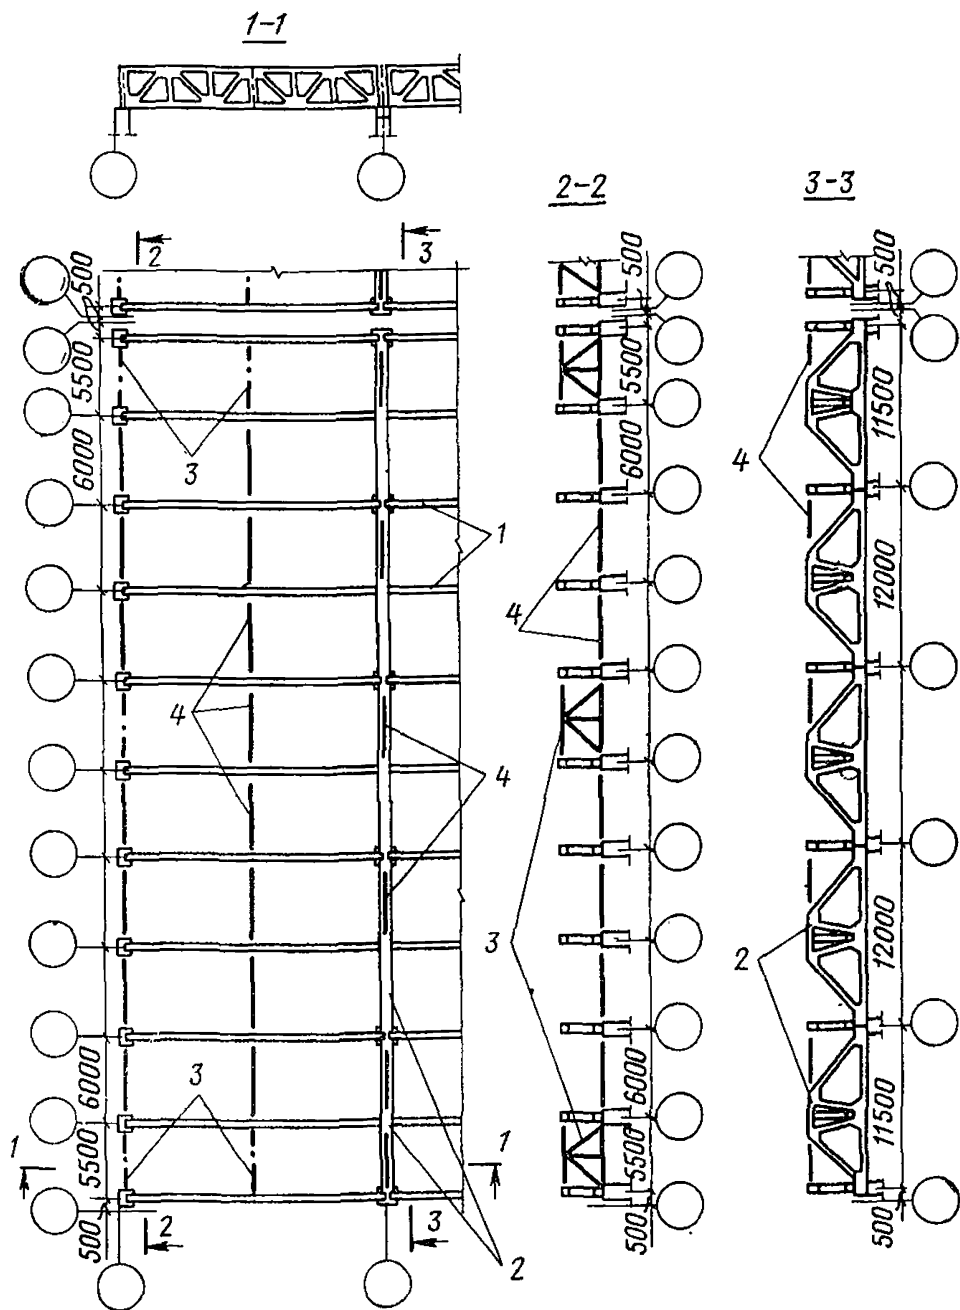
Пример расположения связей покрытия с фермами (при плоской кровле) в зданиях с шагом крайних колонн 6 м и средних 12 м при расчетной сейсмичности 8 баллов
